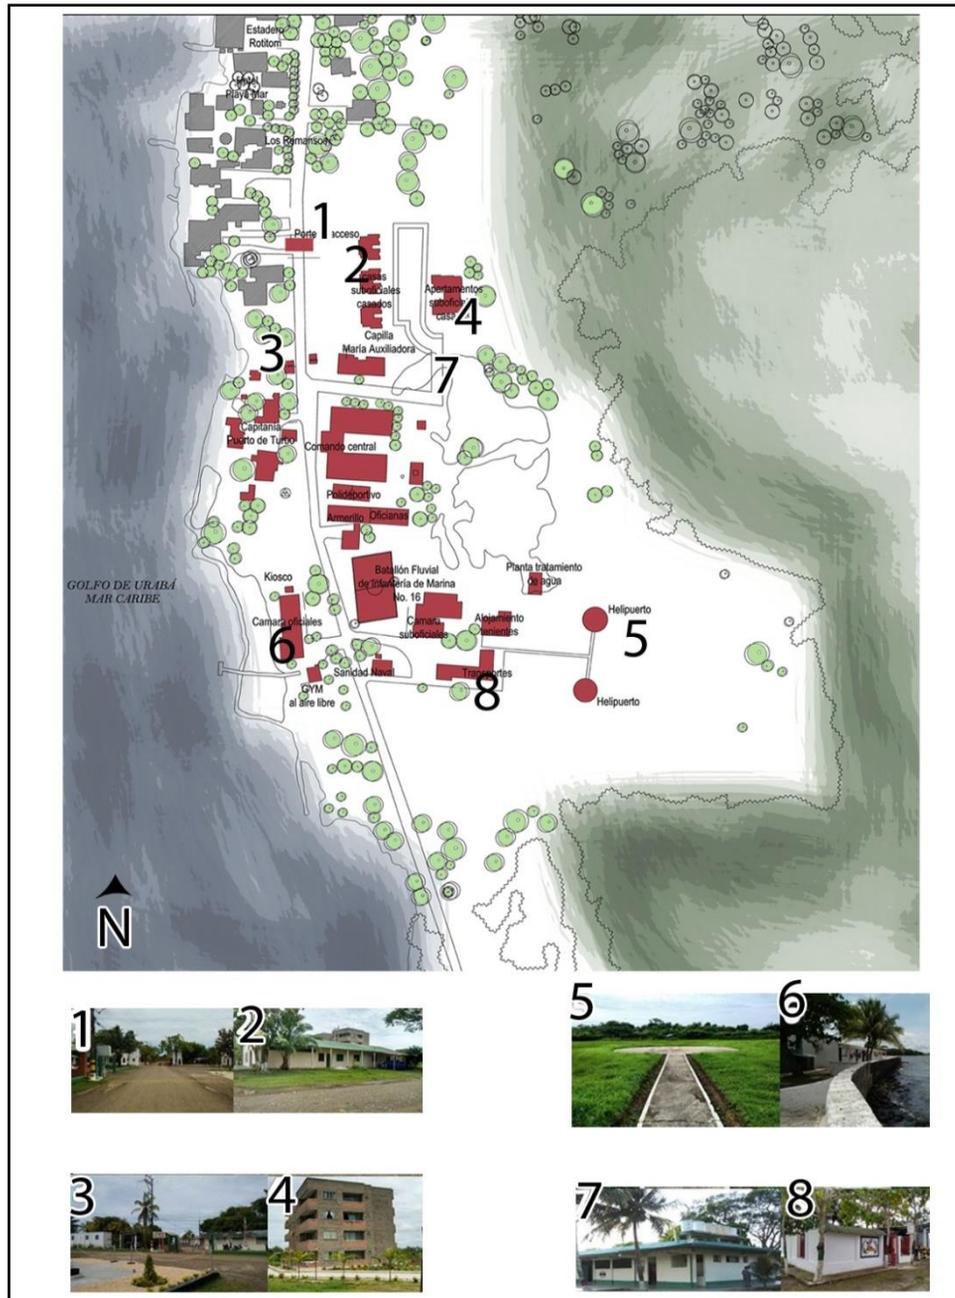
Plano área de intervención construcciones existentes Fuente: Autor
